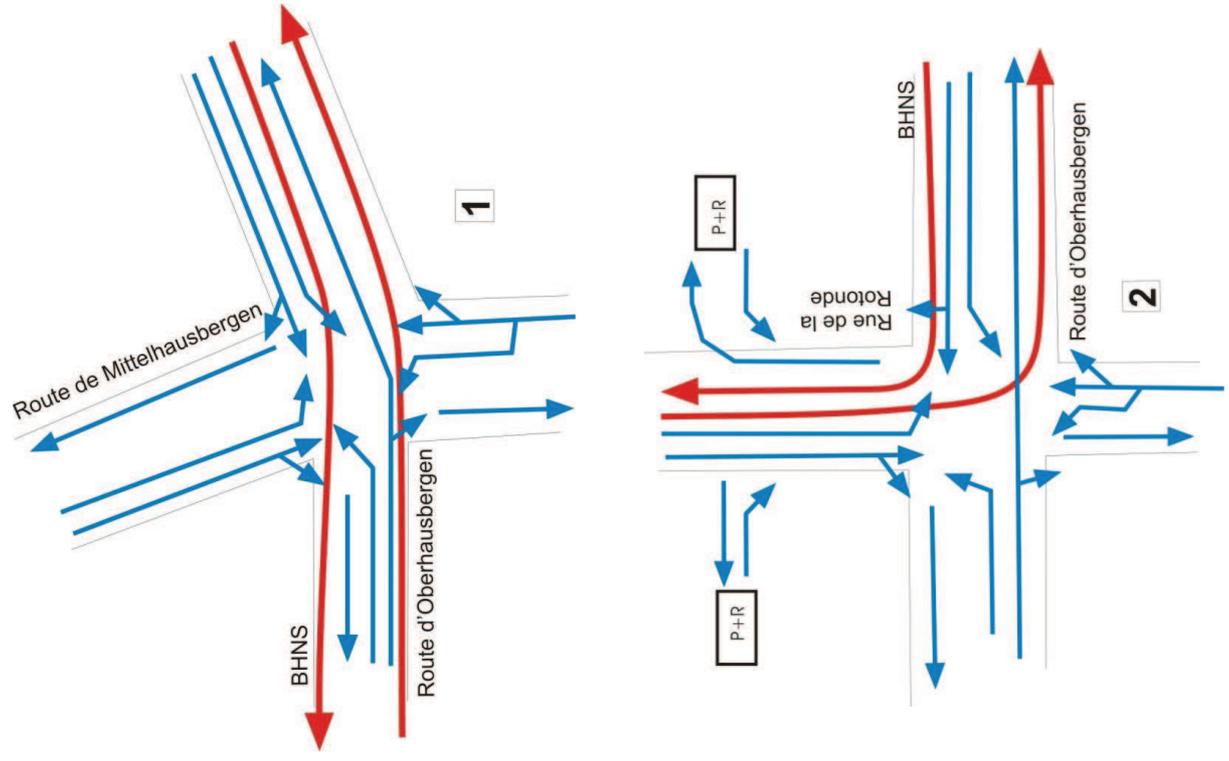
Plan de circulation bus et voiture secteur "Rotonde Sud" (BHNS/1 ou BHNS/2)
